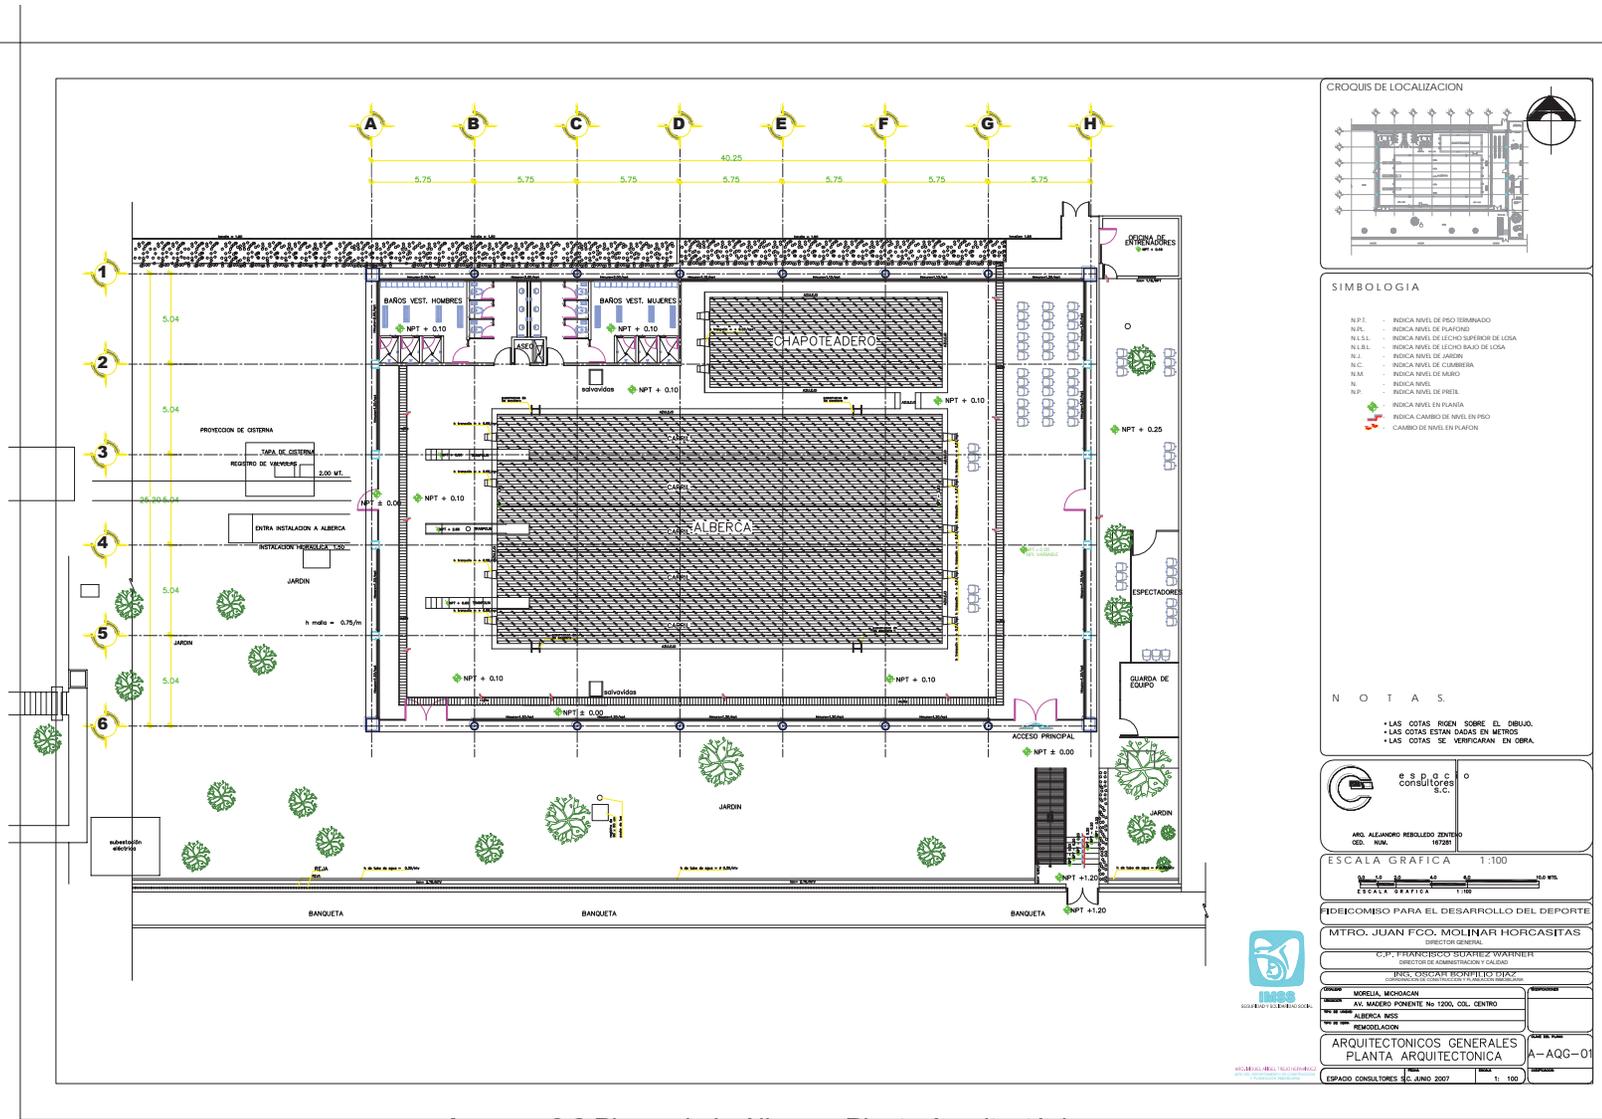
Plano de la Alberca Planta Arquitectónica
